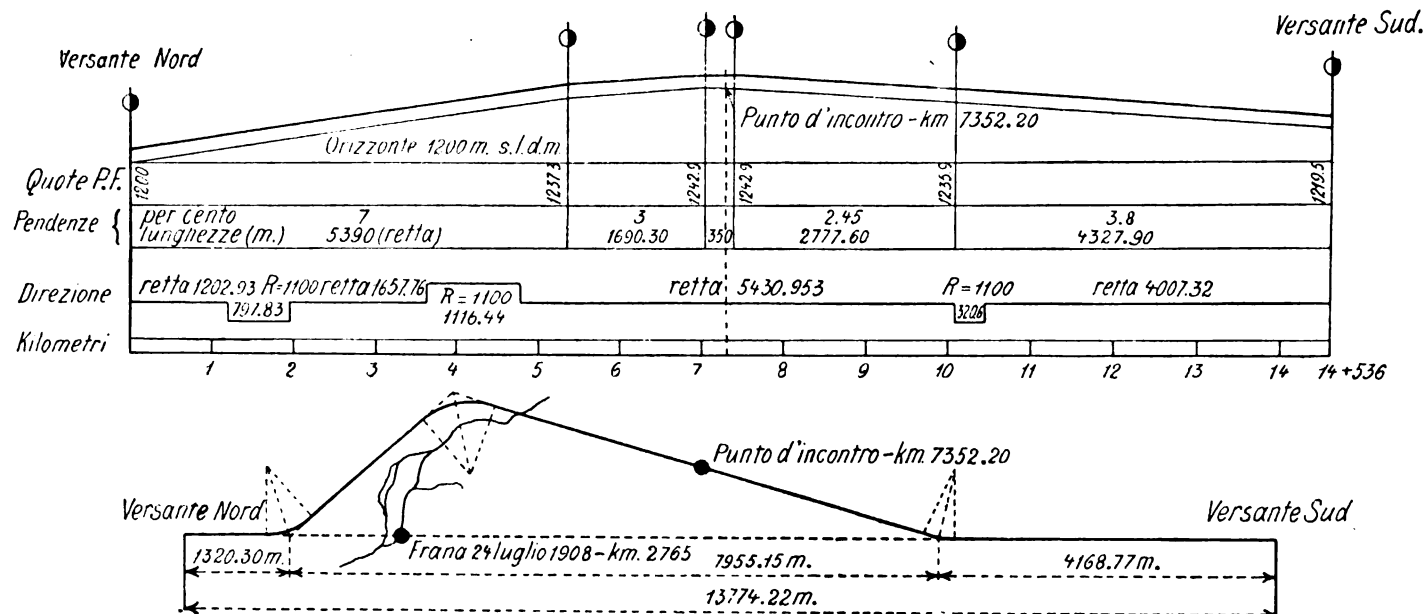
Profilo e pianta del tunnel del Lötschberg.
